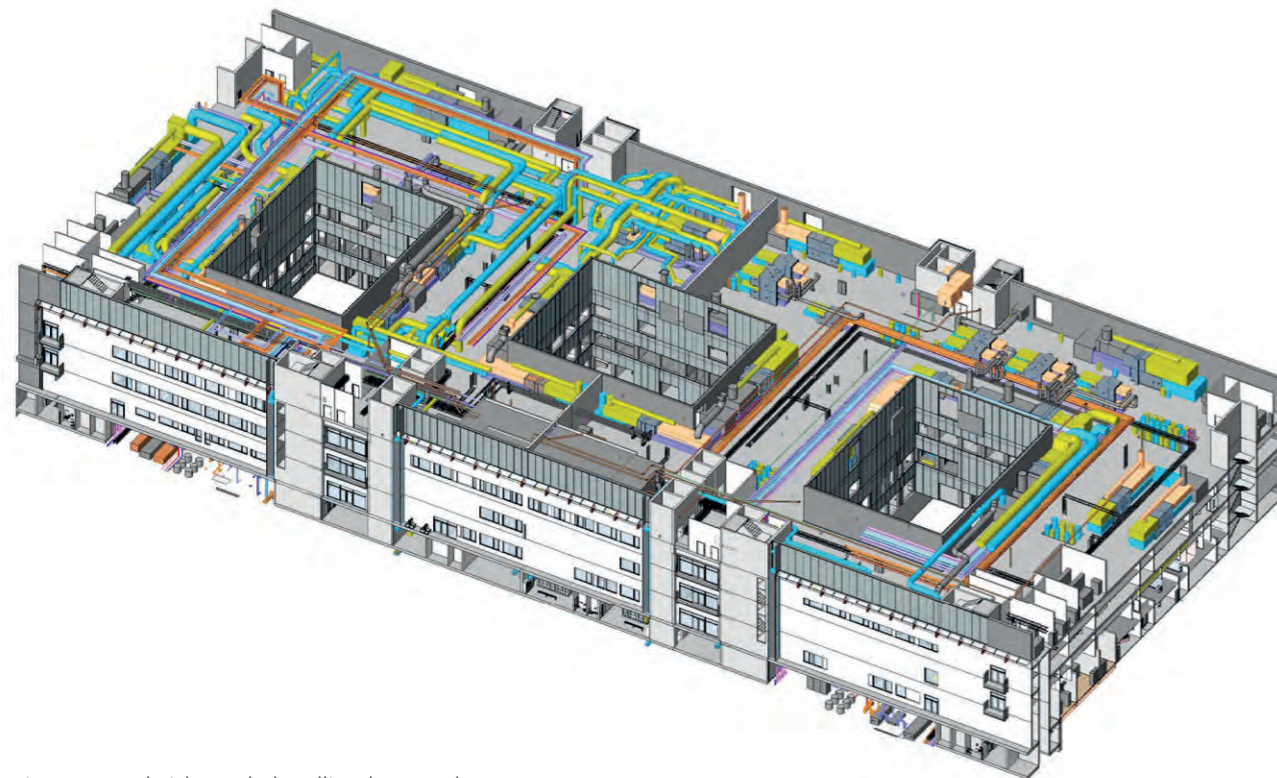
Teknisk rom behandlingsbygget plan 4
